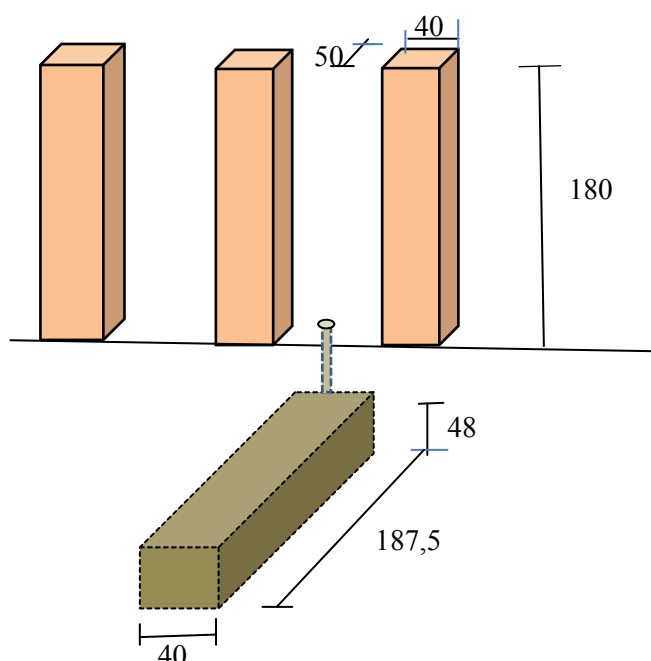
Землескреб в насыщенных радоном грунтах и с системой вентиляции, достаточной для воздухообмена трех небоскребов
